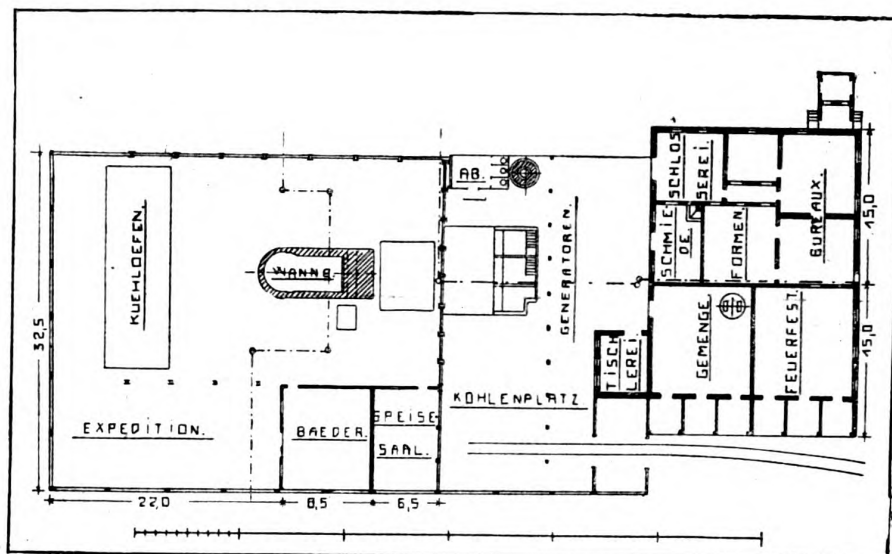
Grundriß einer Glasfabrik (Flaschenhütte).
